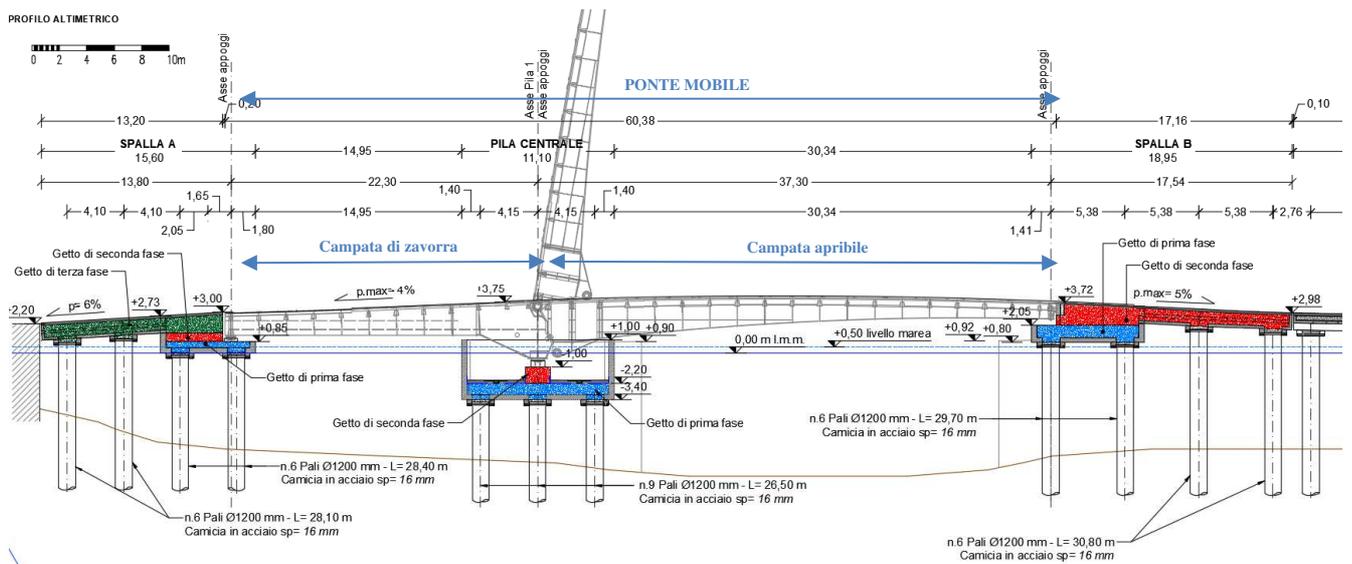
Profilo altimetrico della viabilità su pali (Spalla A, Pila Centrale, Spalla B)
